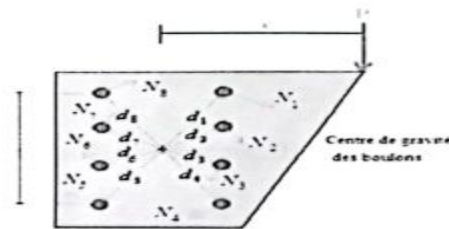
Assemblage par groupe de boulons travaillant à la torsion
